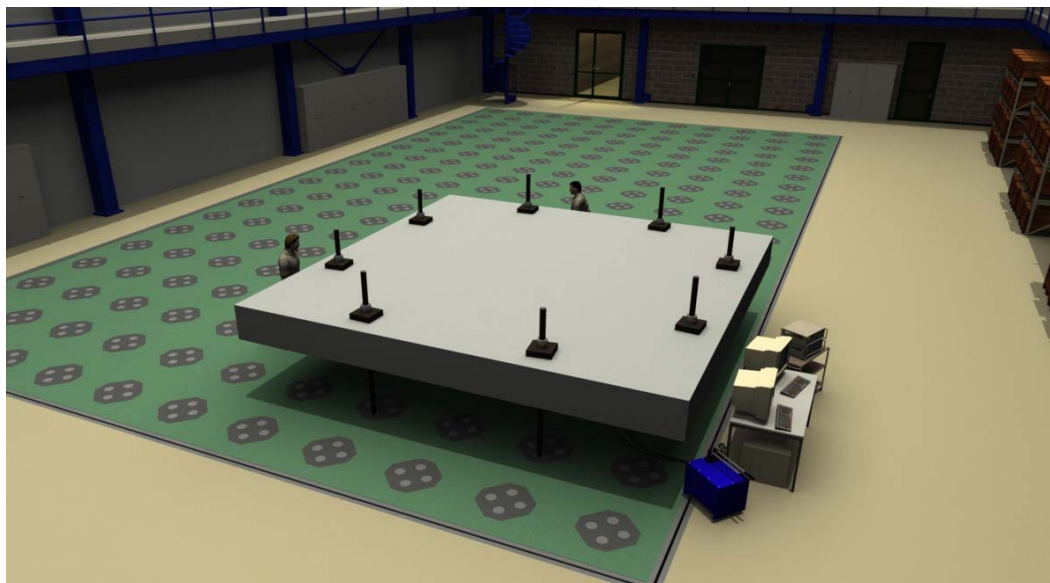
Image virtuelle de la dalle PG-3 dans la halle de structures (image créée par Sylvain Demierre)
